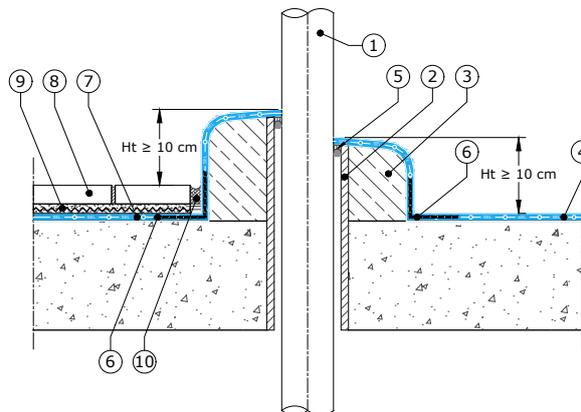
Exemple de traversée d'une descente d'eaux pluviales sur massif avec fourreau
